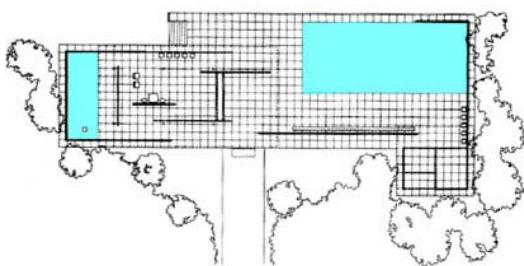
Pavilhão de Barcelona – planta baixa - 1929
